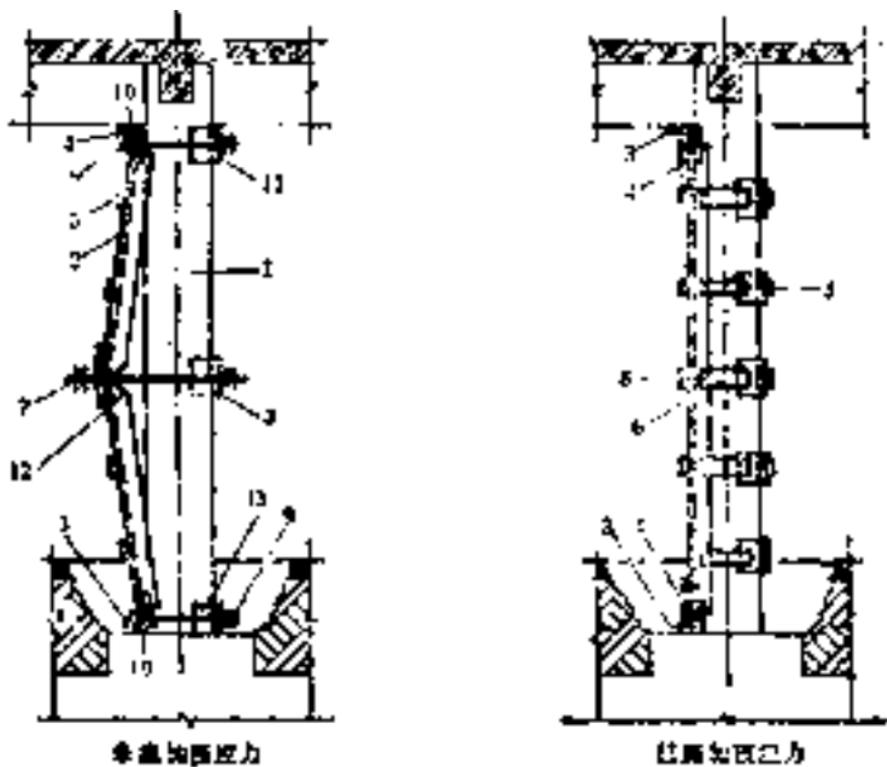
钢筋混凝土柱单侧预应力加固撑杆结构
